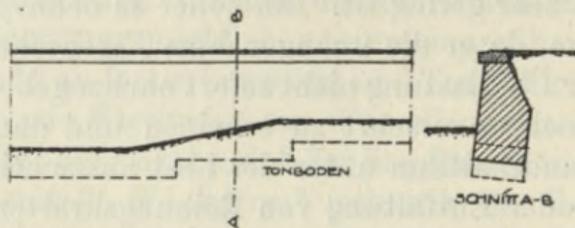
Abtreppung einer auf Tonboden ruhenden Grundbausohle.
